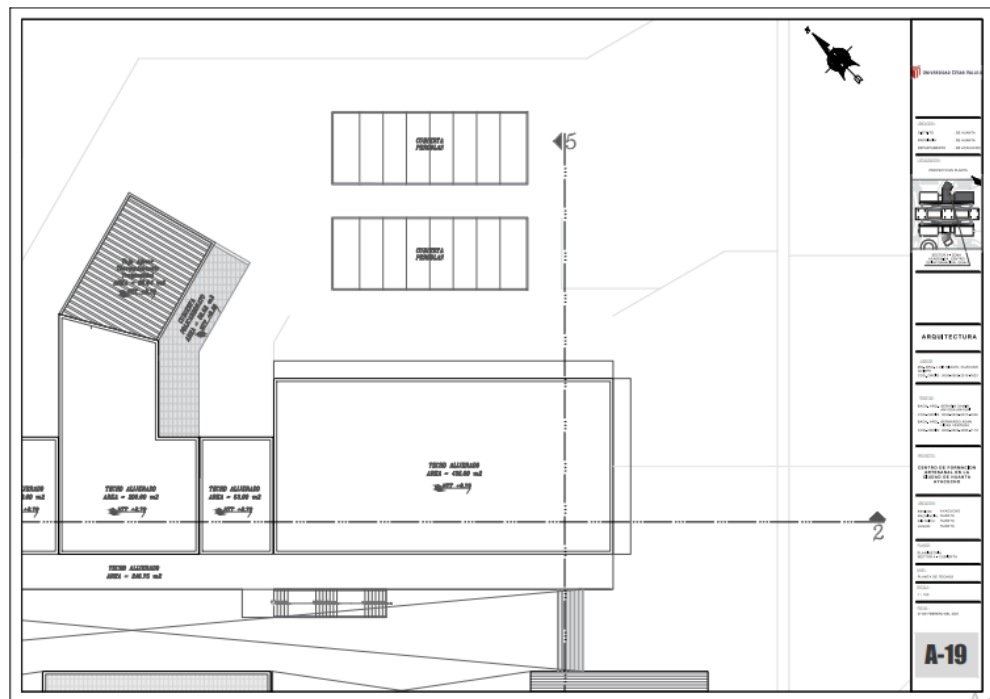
Planimetría de techos del sector 4. Escala 1/100.
